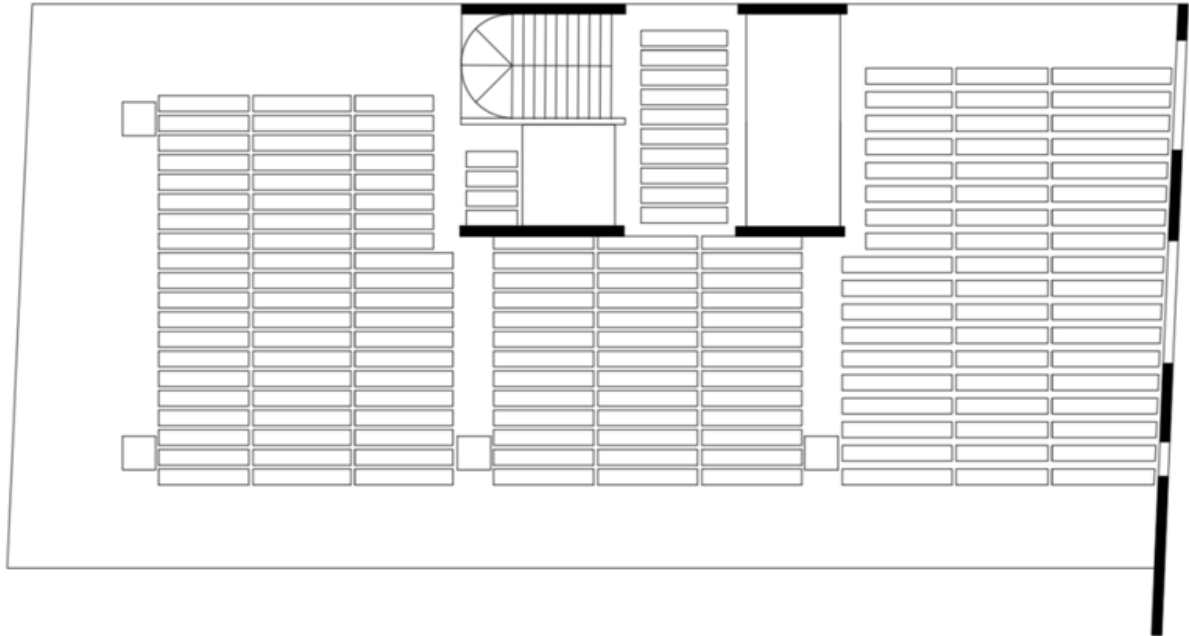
Esquema de la losa nervada (Fuente: FAU-USP)
